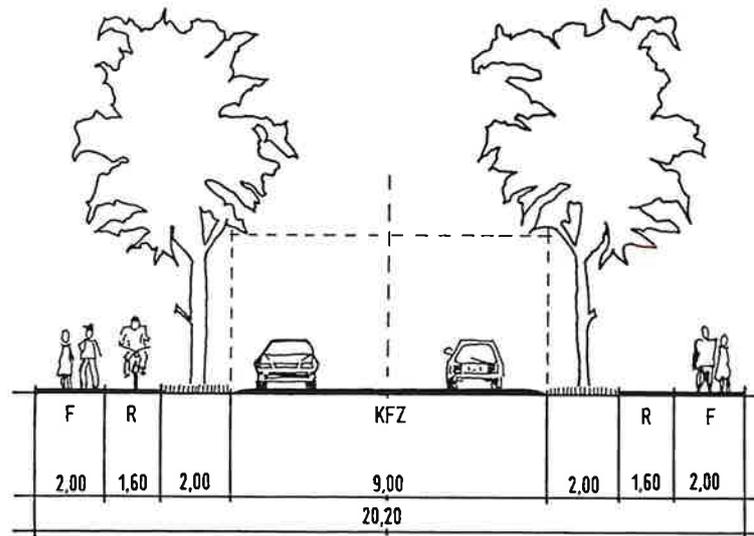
HAUPTSAMMELSTRASSE, ERNST-SCHNELLER-STRASSE, A₄-A₄
